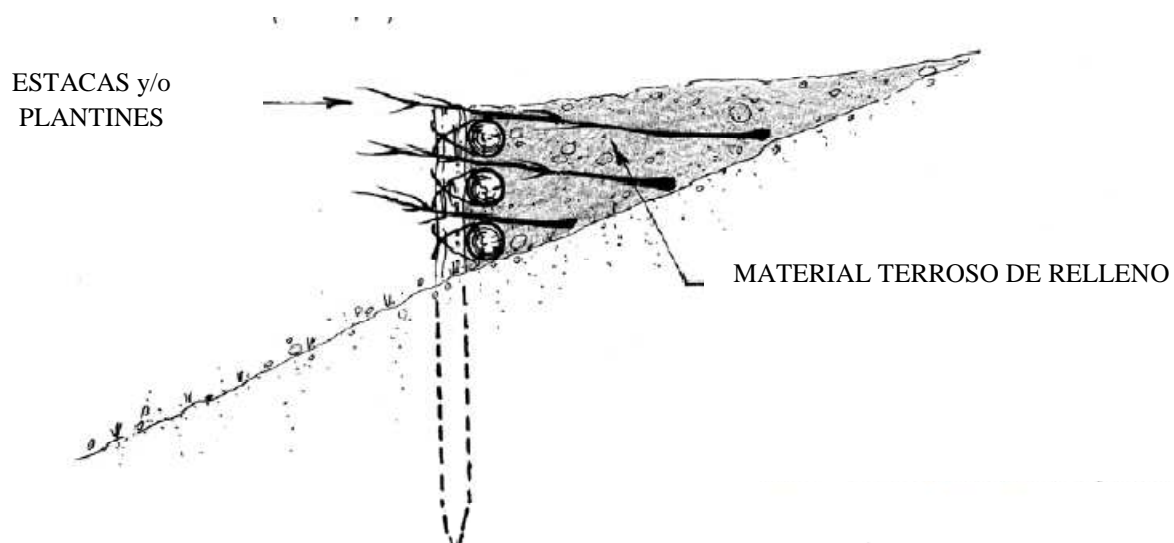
a - Trincho vivo - Vista lateral (FERRARI; 2008)
